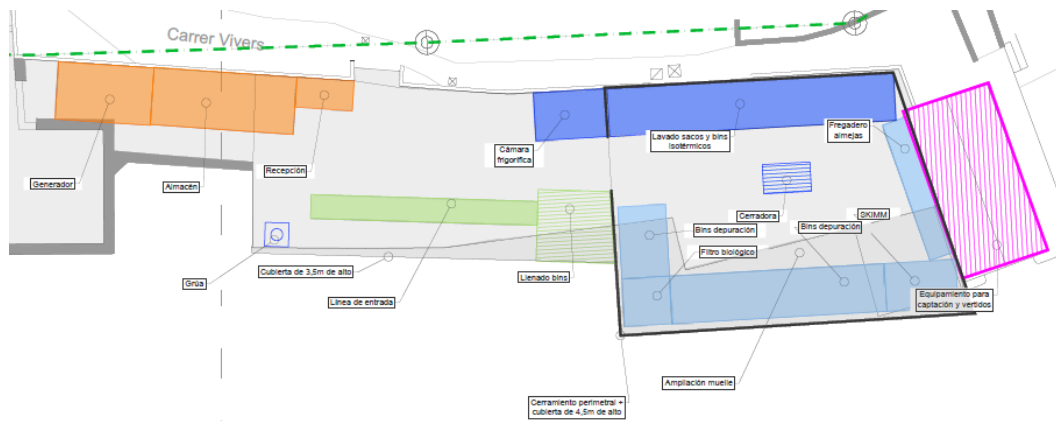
Planta propuesta para la alternativa 2 en las parcelas 8, 9 y 10.
